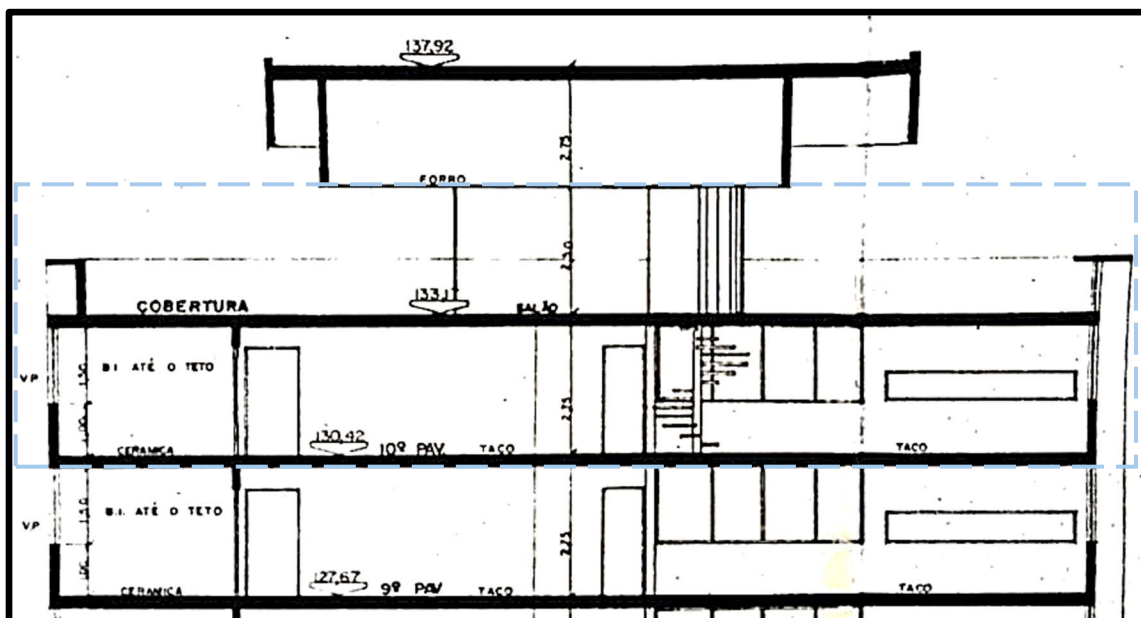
Planta - Vista Lateral (Corte) sem 3º Pavimento
